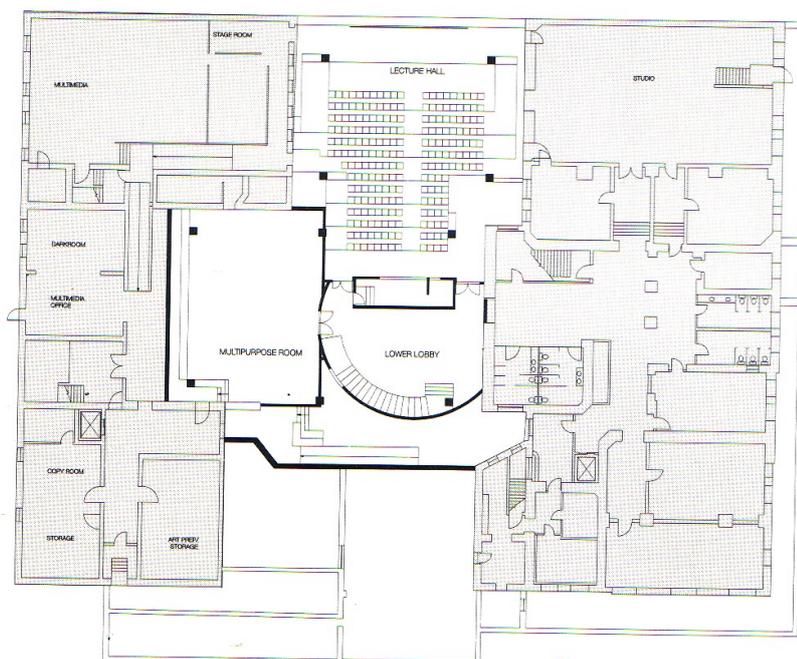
Planta do piso -1 (Planta sem escala)
